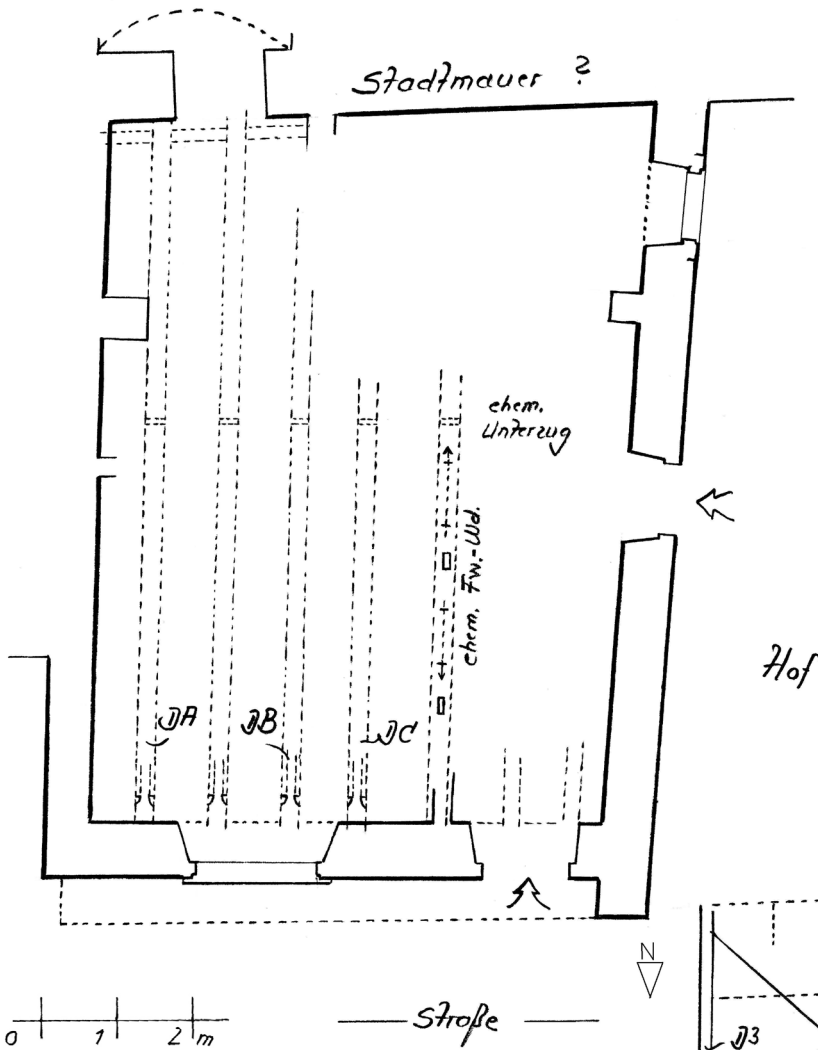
Spitalstraße 22, Grundriss Erdgeschoss, 1667 (d).
